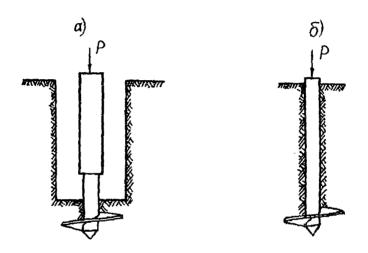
Рис I. Скемы испытаний грунта винтовым штампом: а — ниже забоя буровой скважины, d — в массиве грунта
